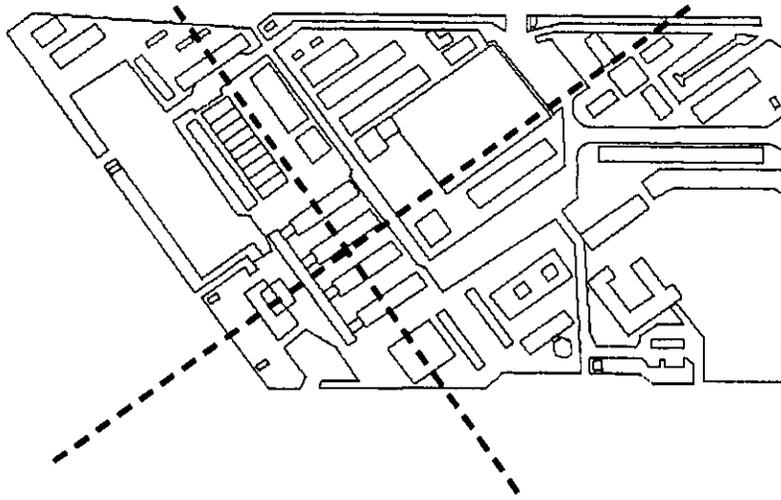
Planta arquitectónica sintetizada para justificar geoméricamente
